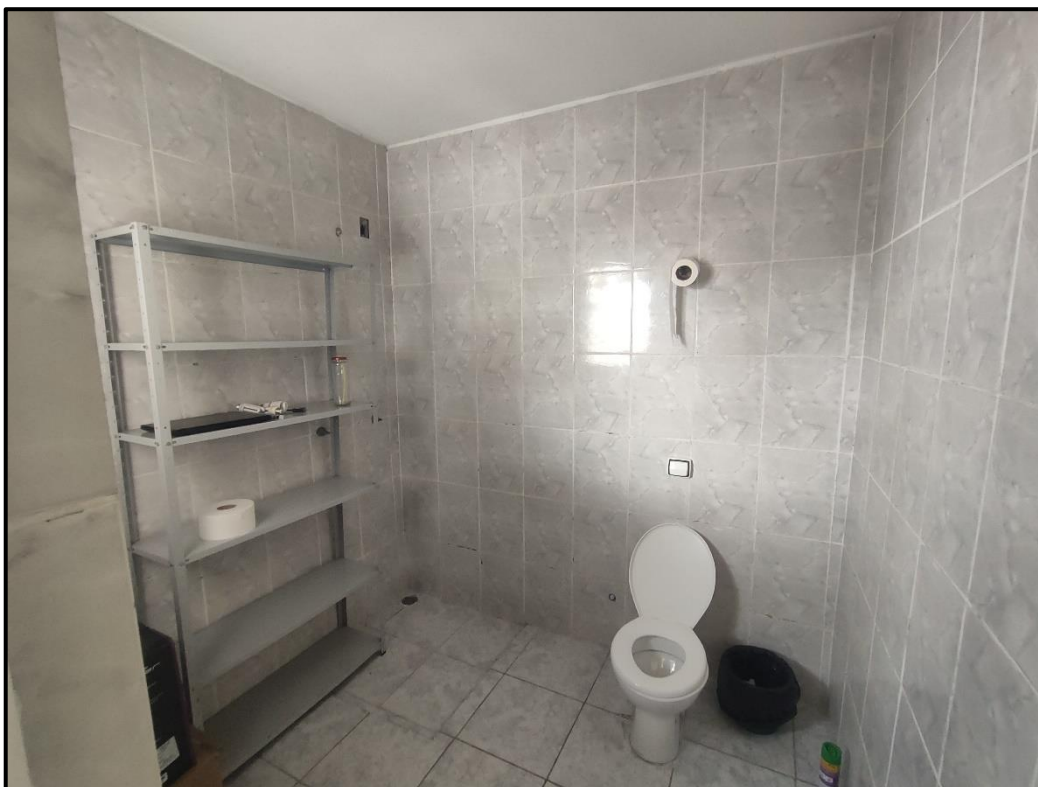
2º pavimento (2º andar) – Sala 05
